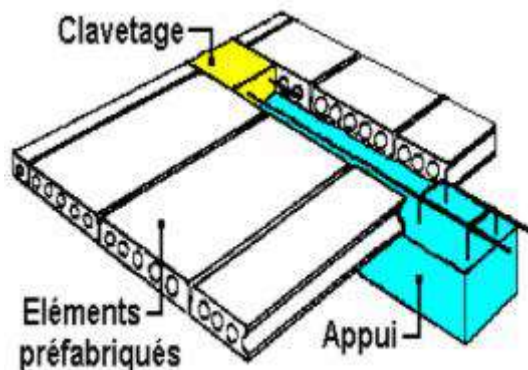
exemple de clavetage d'un ouvrage en béton armé
